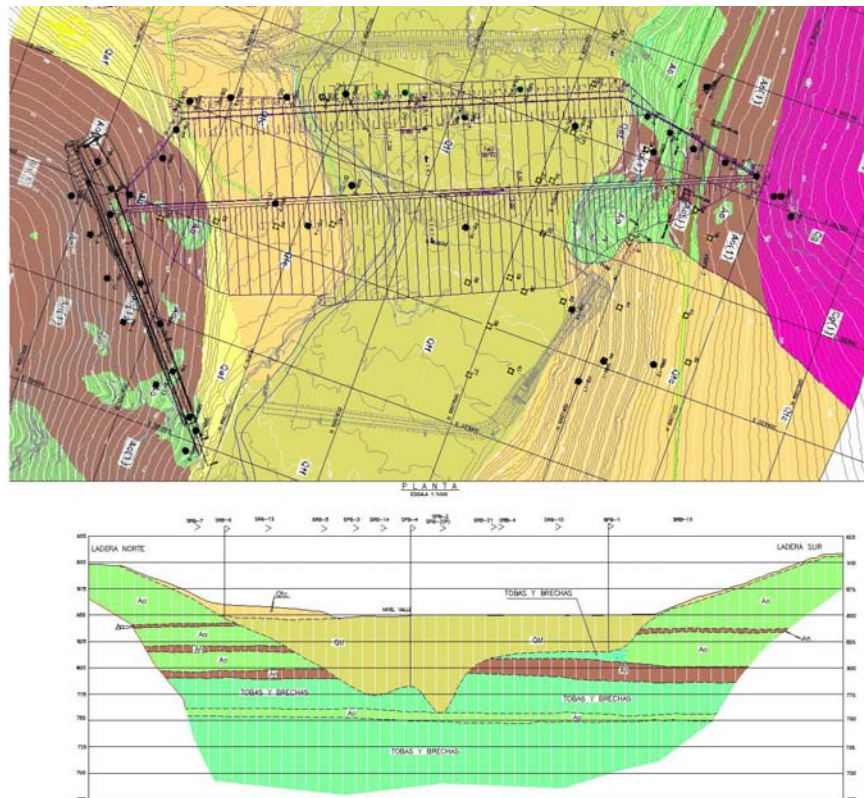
Geología de la cerrada. Planta y perfil por el eje de presa
